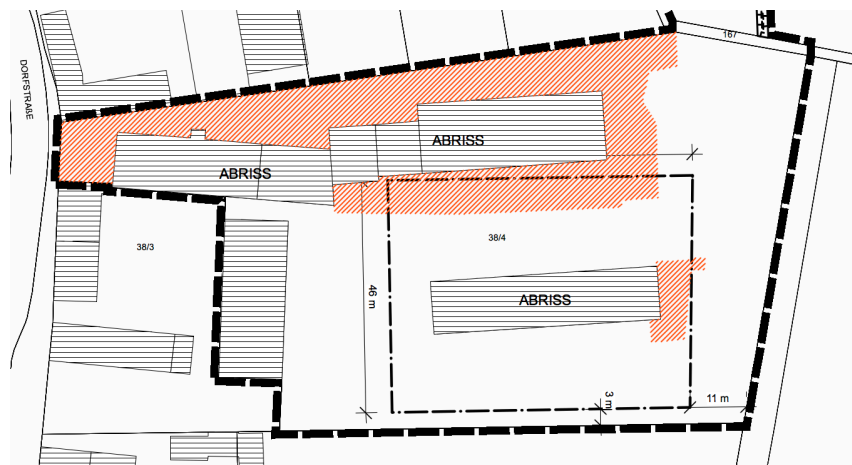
versiegelte Verkehrs-, Lager- und Gebäudeflächen
